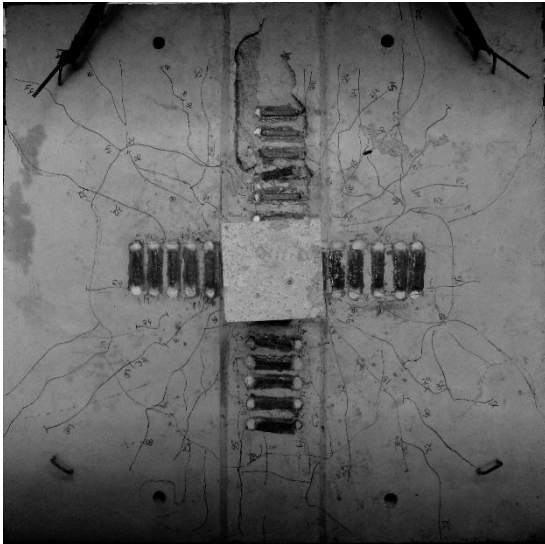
Padrão de Fissuração - LC-S1-F2
